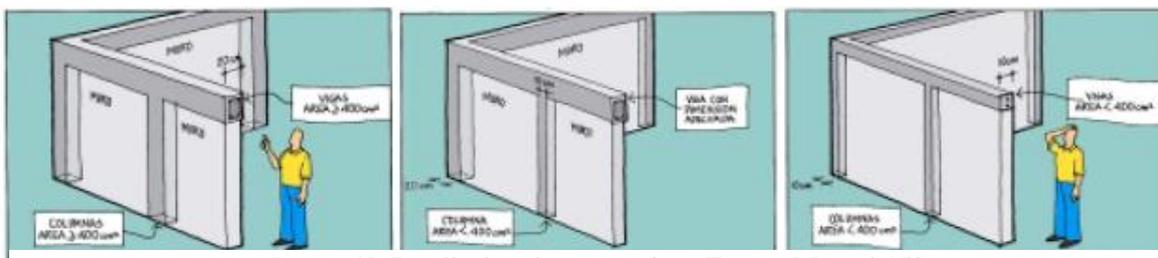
Detalle de columnas y vigas. Fuente: Manual AIS
